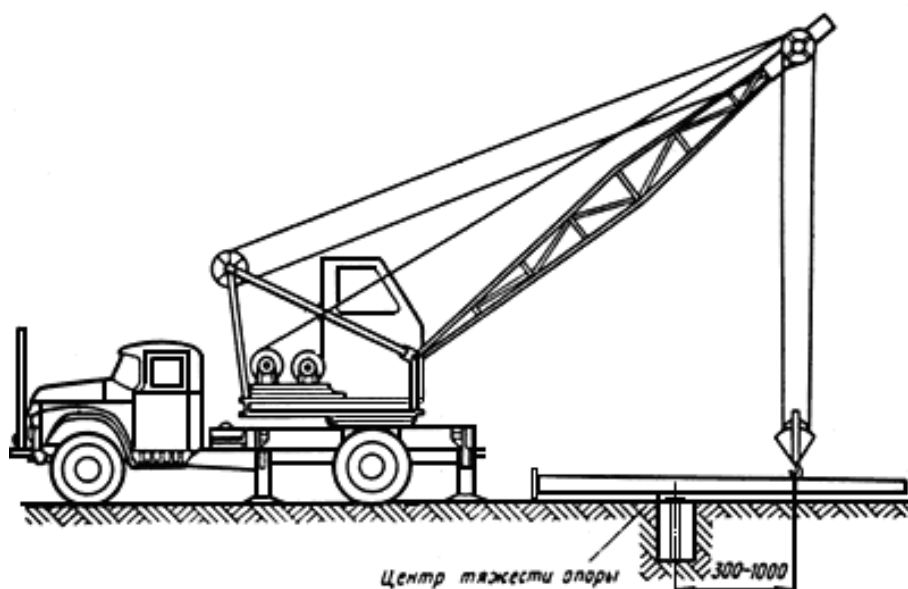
Выкладка опоры перед установкой ее в котлован или на фундамент автомобильным краном
